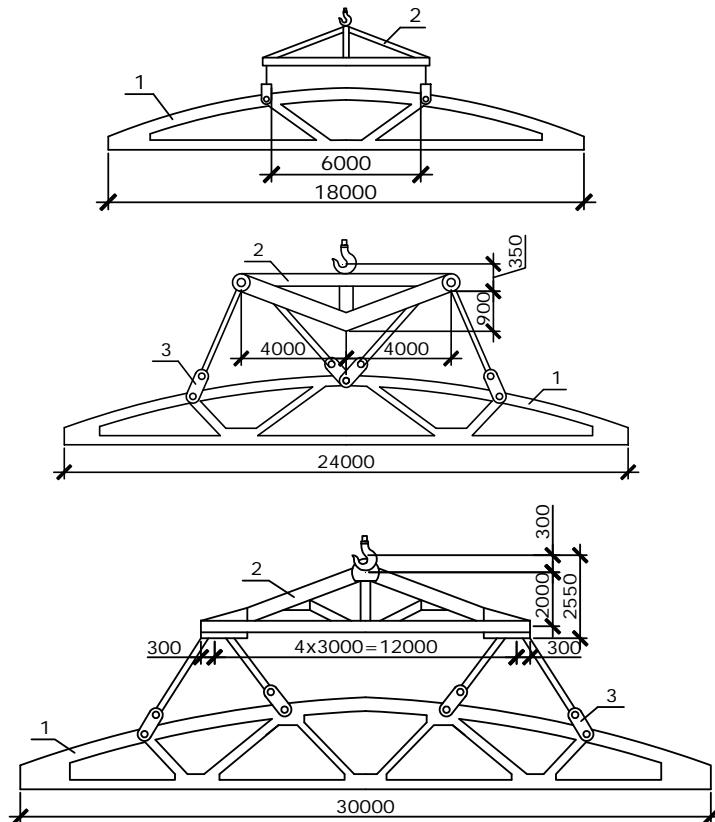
Строповка железобетонных ферм с помощью траверс:
